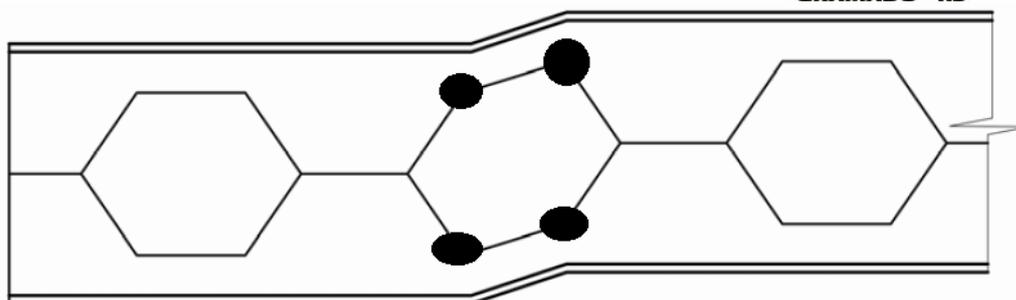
Formação de mecanismo Vierendel em vigas casteladas
